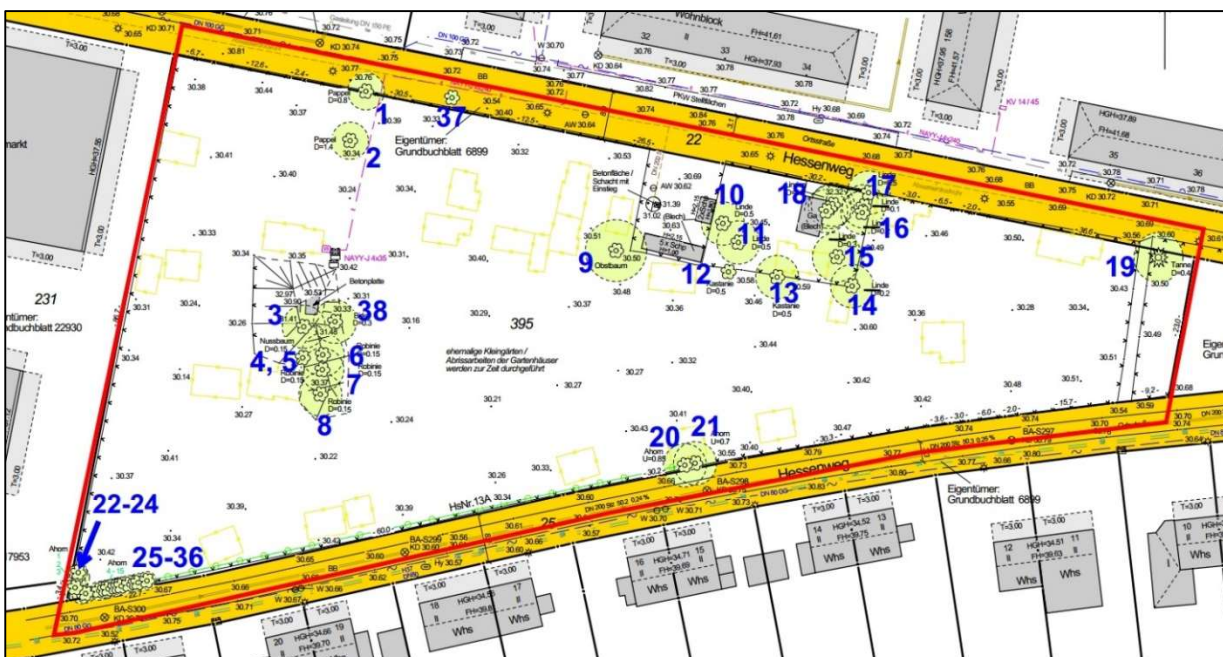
Baumbestand im Plangebiet auf der Grundlage des Vermesserplans mit Stand Oktober 2022
